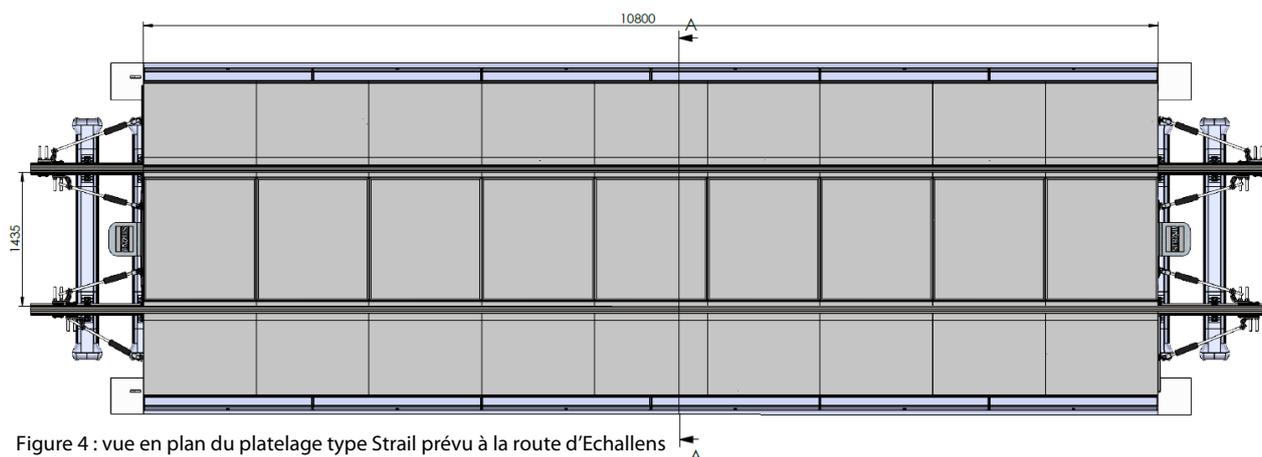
vue en plan du platelage type Strail prévu à la route d'Echallens
